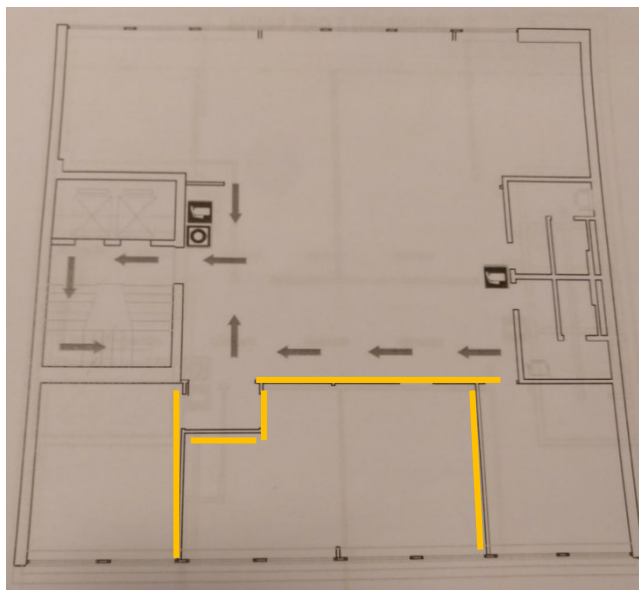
Planta do Piso 1 existente, divisórias a demolir
